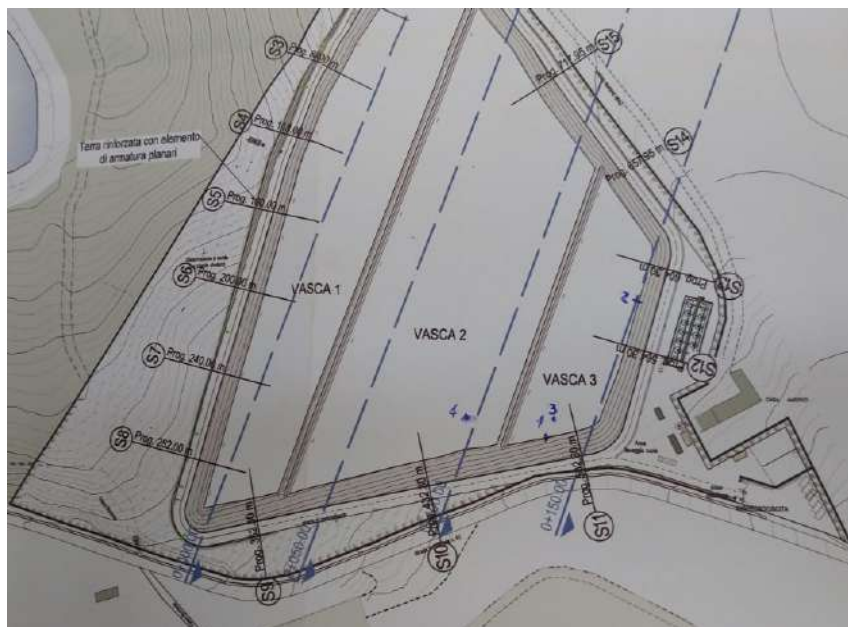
Posizione di prelievo dei campioni C1, C2, C3 e C4 sulla planimetria di progetto della discarica Borranea
